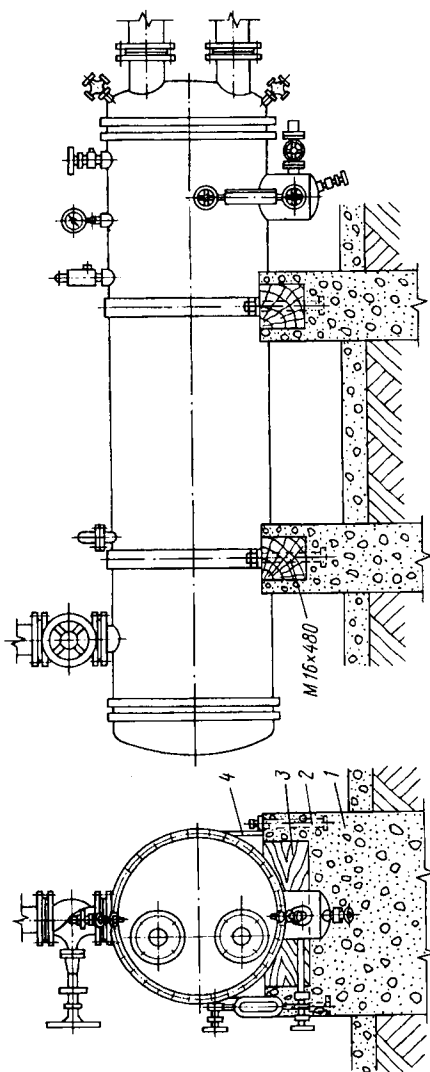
Размещение на фундаменте кожухотрубного конденсатора:
